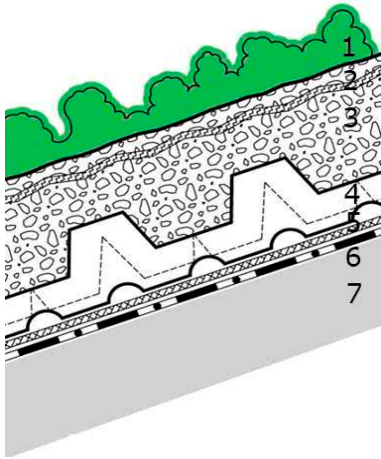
Система «Скатная кровля с углом наклона до 20°С
